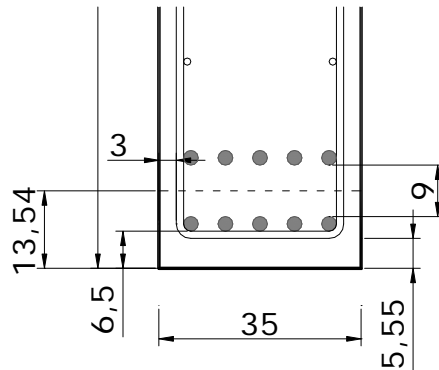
Detalle de la ubicación del refuerzo longitudinal por flexión
